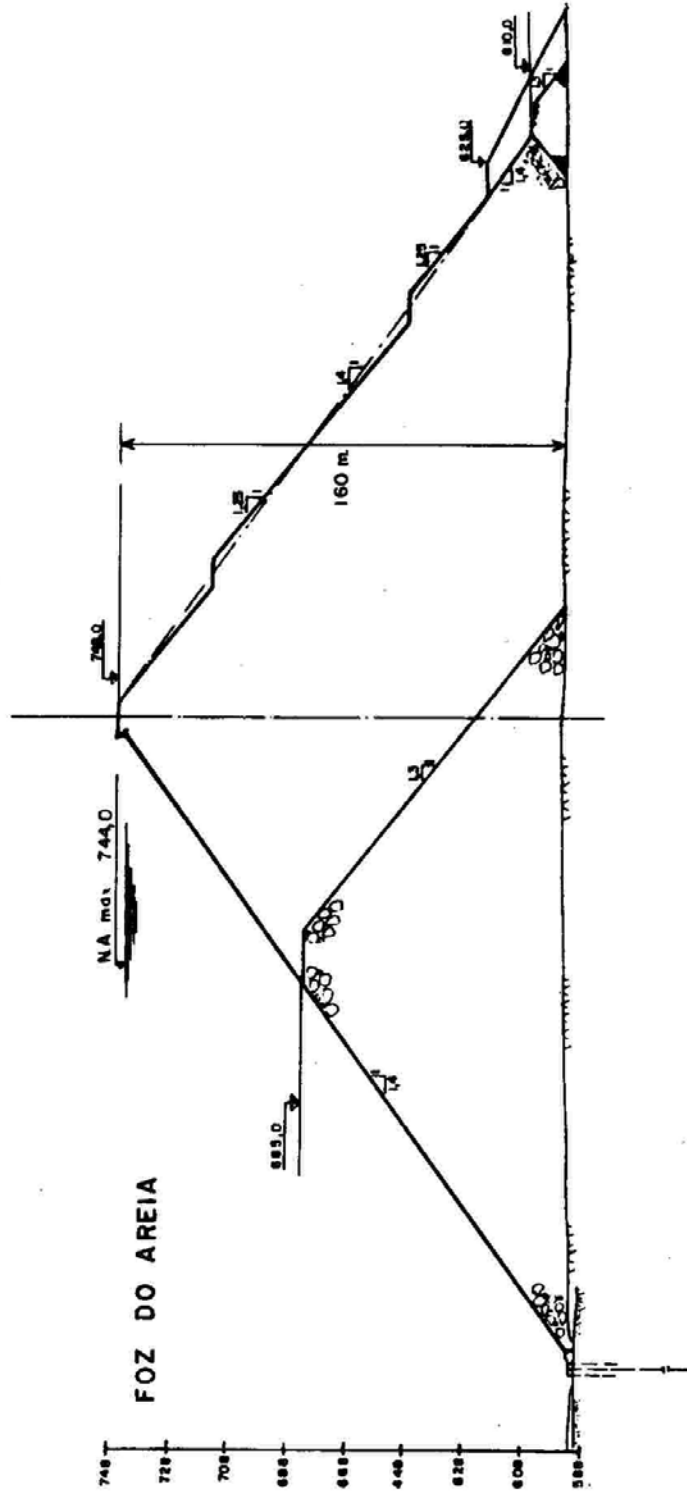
Secção típica de barragem tipo enrocamento com face de concreto.
